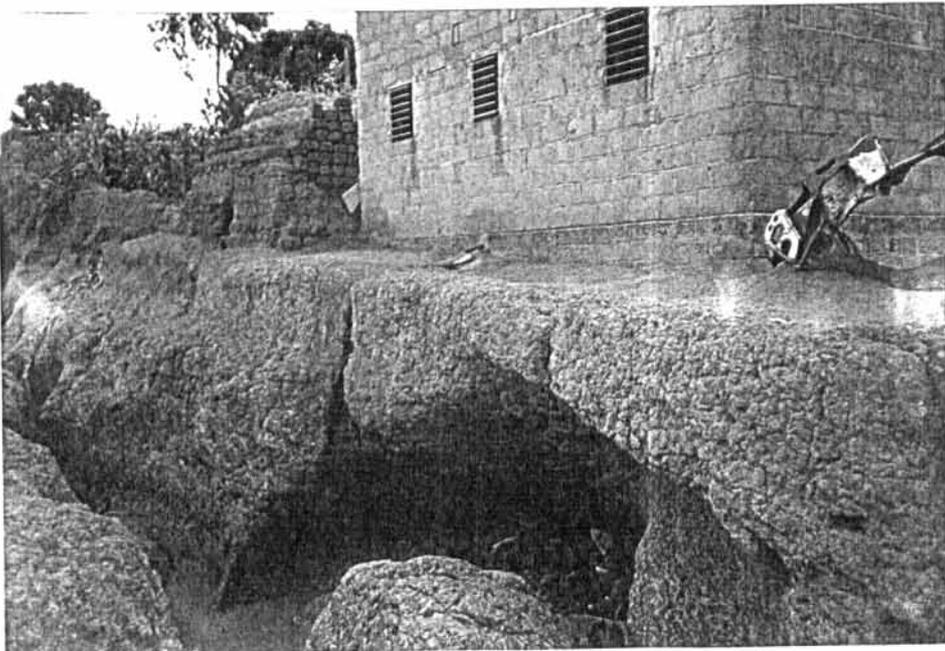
Affouillement très actif sous la fondation d'une maison à Nienèta. Suite logique de la dégradation du caniveau N°1
